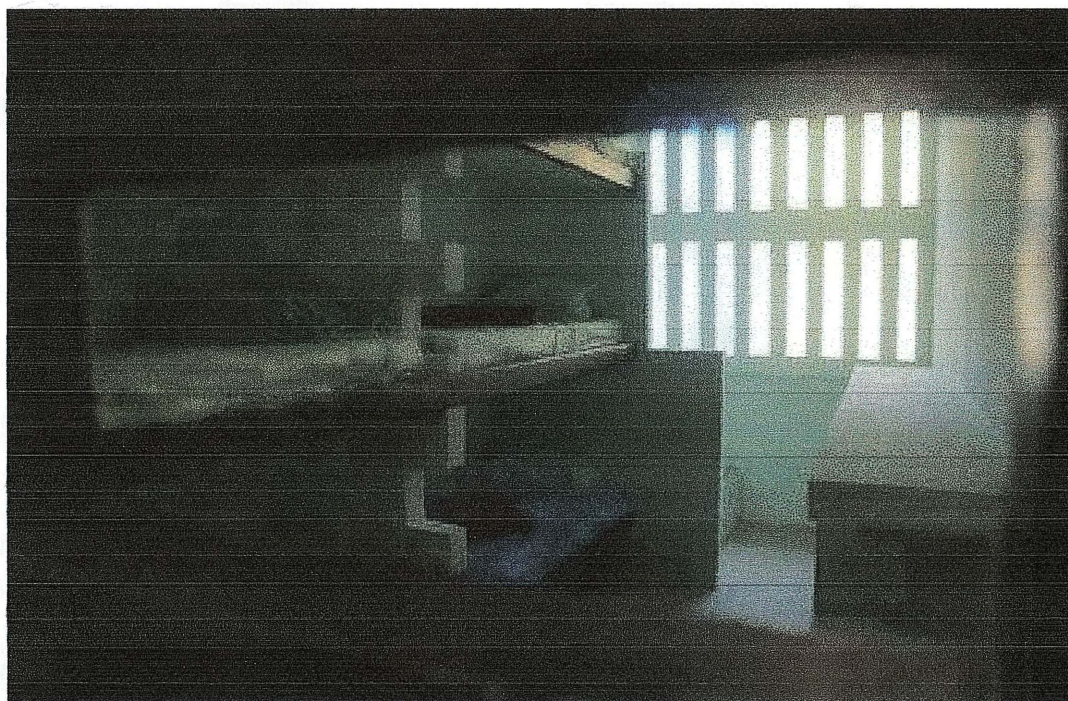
BRISES EM BLOCOS DE CONCRETO
